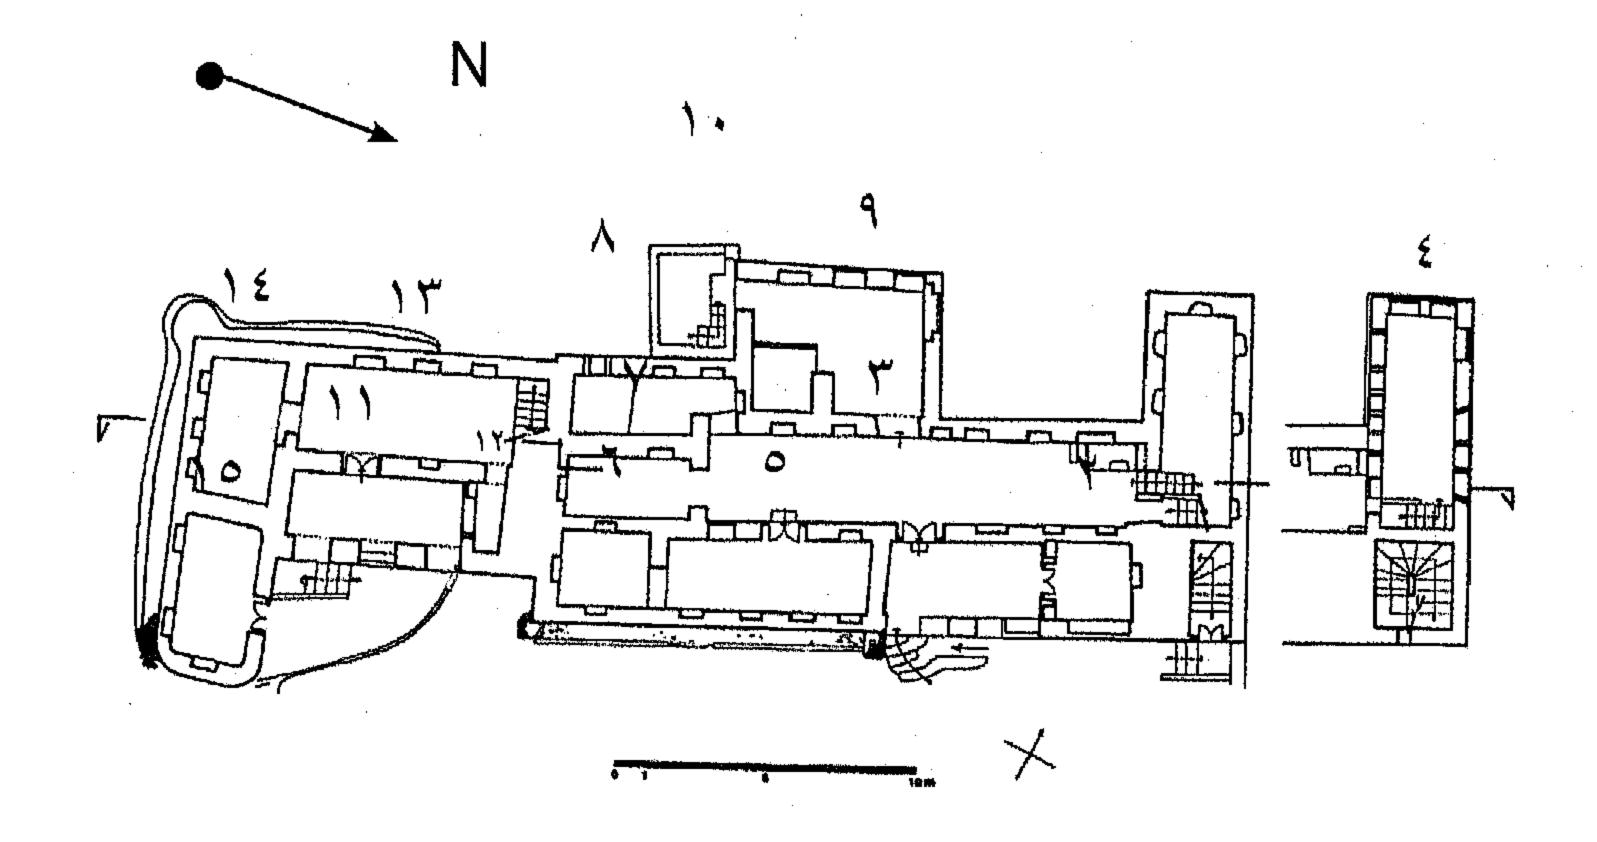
قصر الحير الشرقي – مسقط أفقي . عن ، Creswell, Allan:
